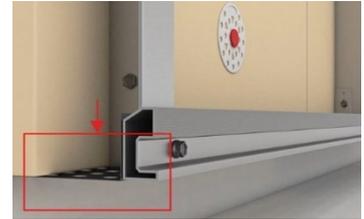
Détail de l'ouverture en pied de la façade ventilée
